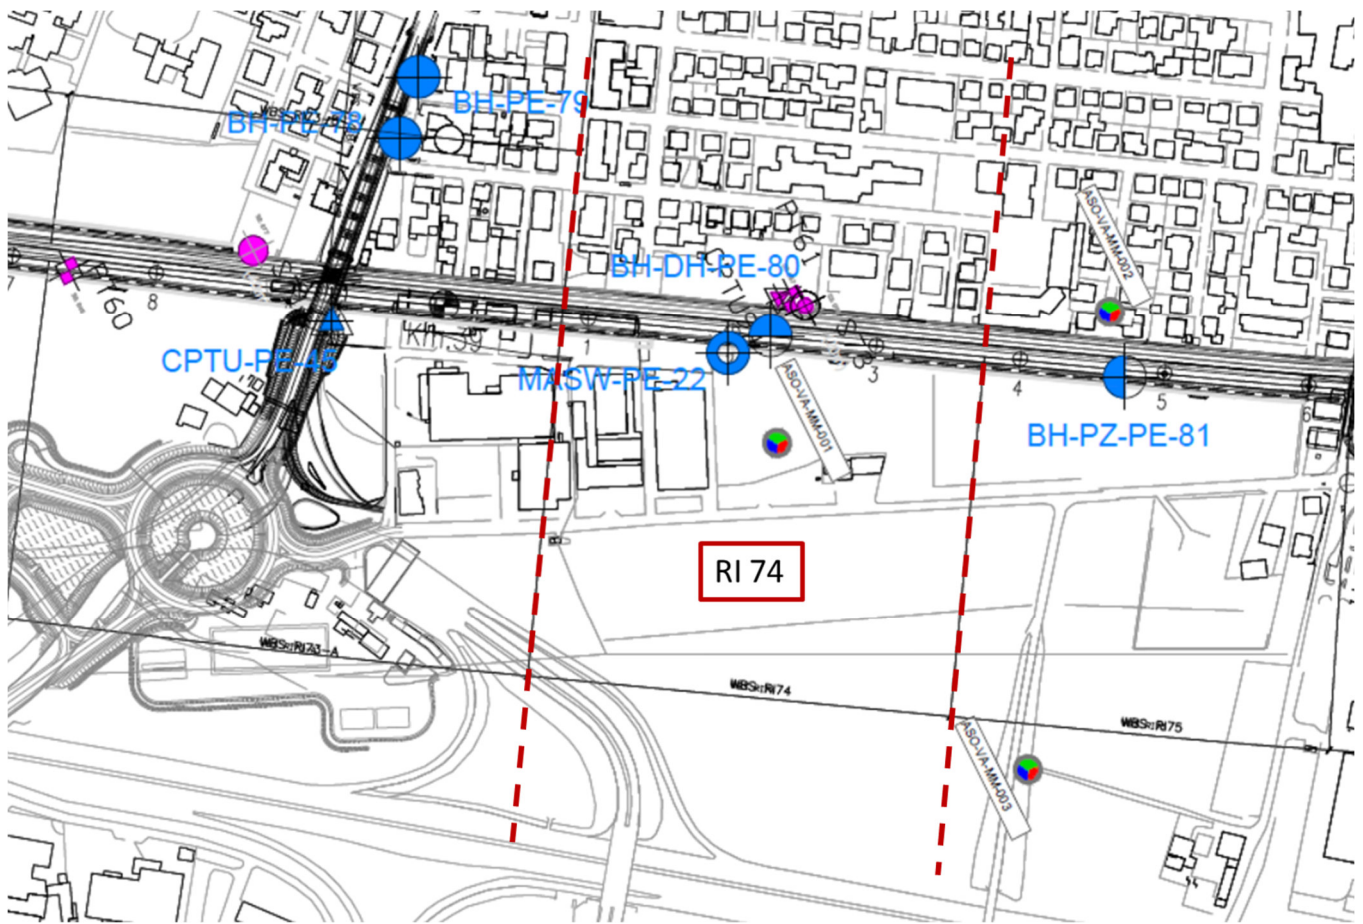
Planimetria Rilevato RI74, estratto dalla Planimetria Generale (Doc. Rif. [3])
